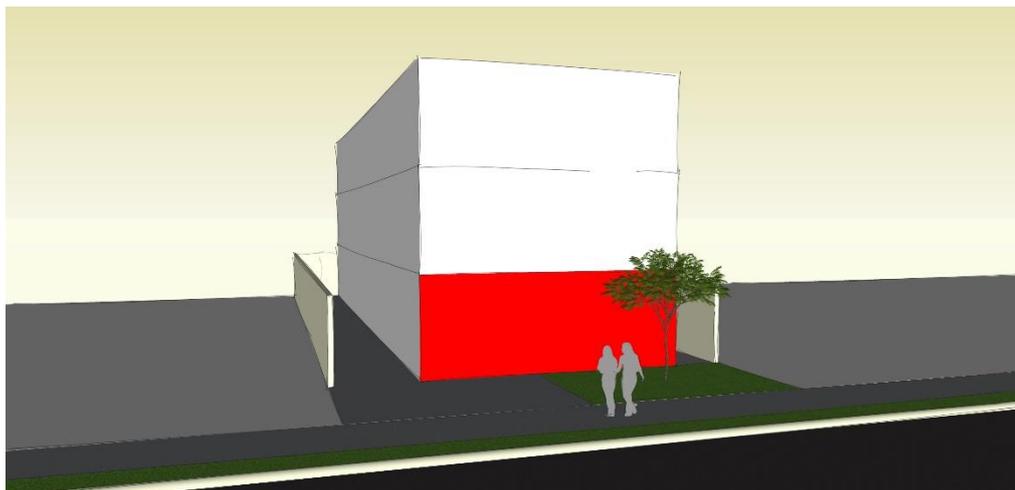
Imagem esquemática da fachada ativa em indústria e comércio – opção 1
